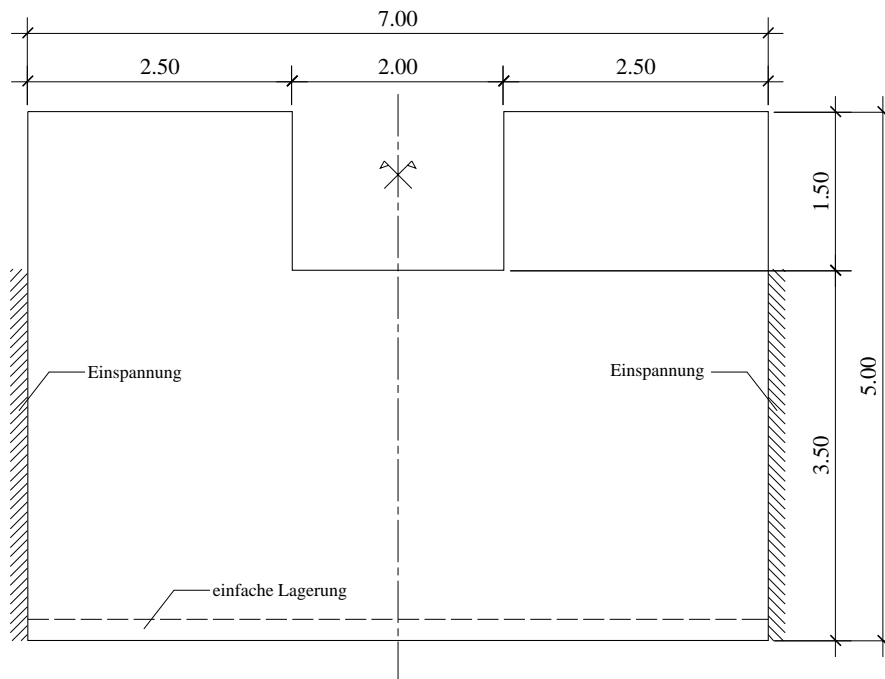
Grundriss der in Aufgabe 2 behandelten Platte. Abmessungen in m.
